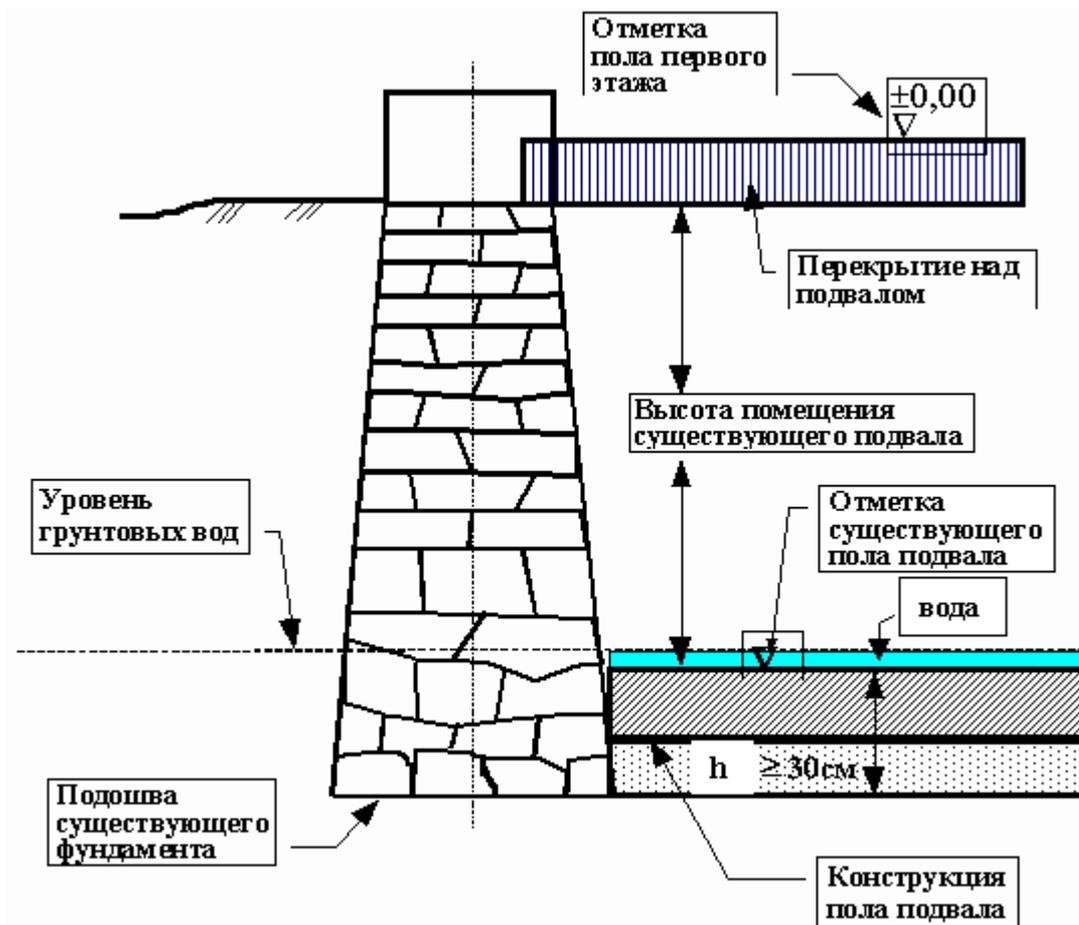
Типичный конструктивный разрез фундамента с подвальным помещением и разрушенной гидроизоляцией при высоком уровне грунтовых вод (У.Г.В.)
